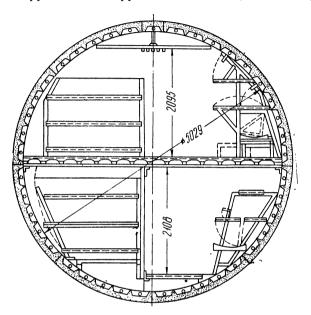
Поперечное сечение убежища для населения с обделкой из железобетонных тюбингов (Лондон)
